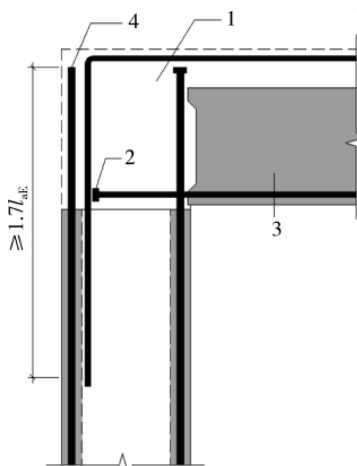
叠合柱及叠合梁框架顶层端节点梁柱外侧钢筋搭接构造示意
